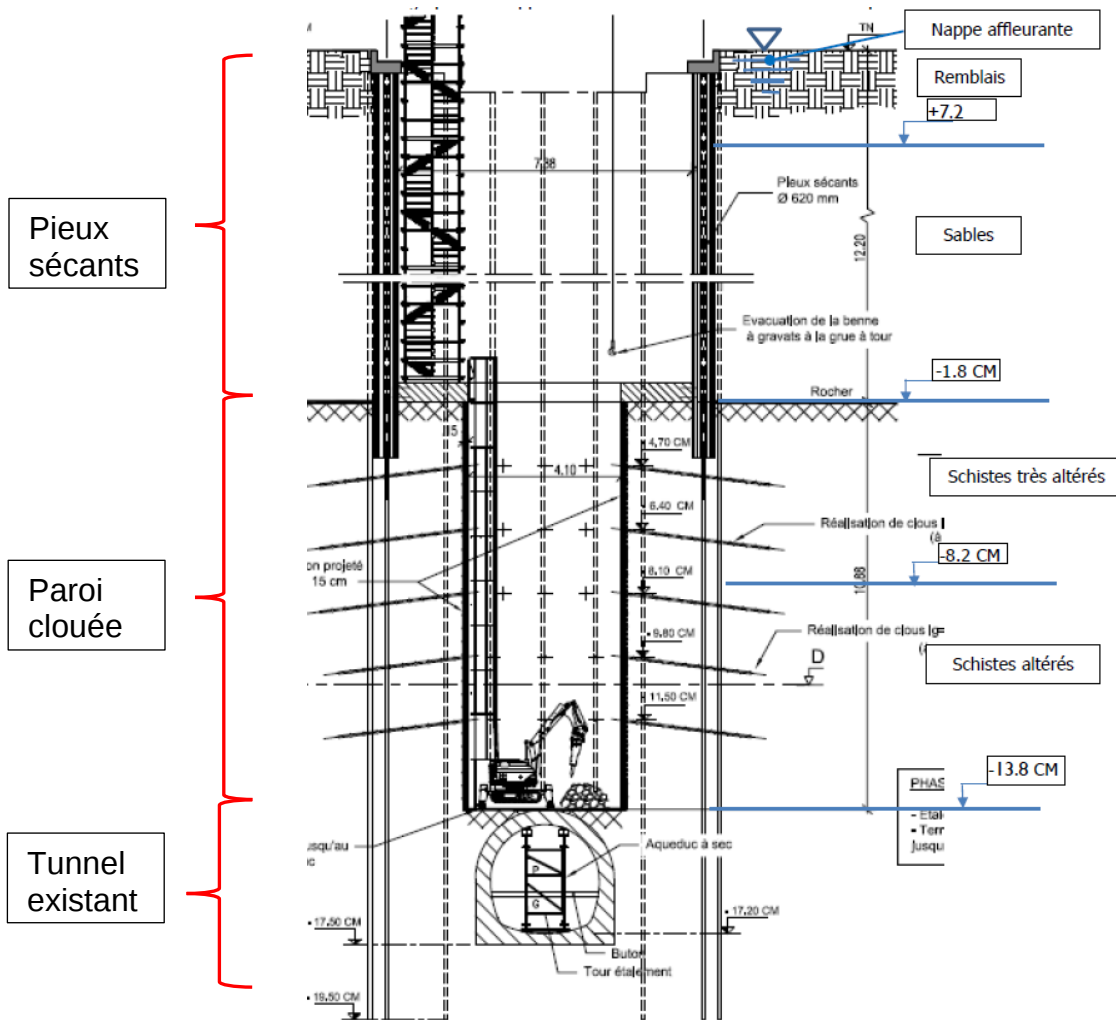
Élévation des deux puits et du tunnel existant (aqueduc) à conforter
